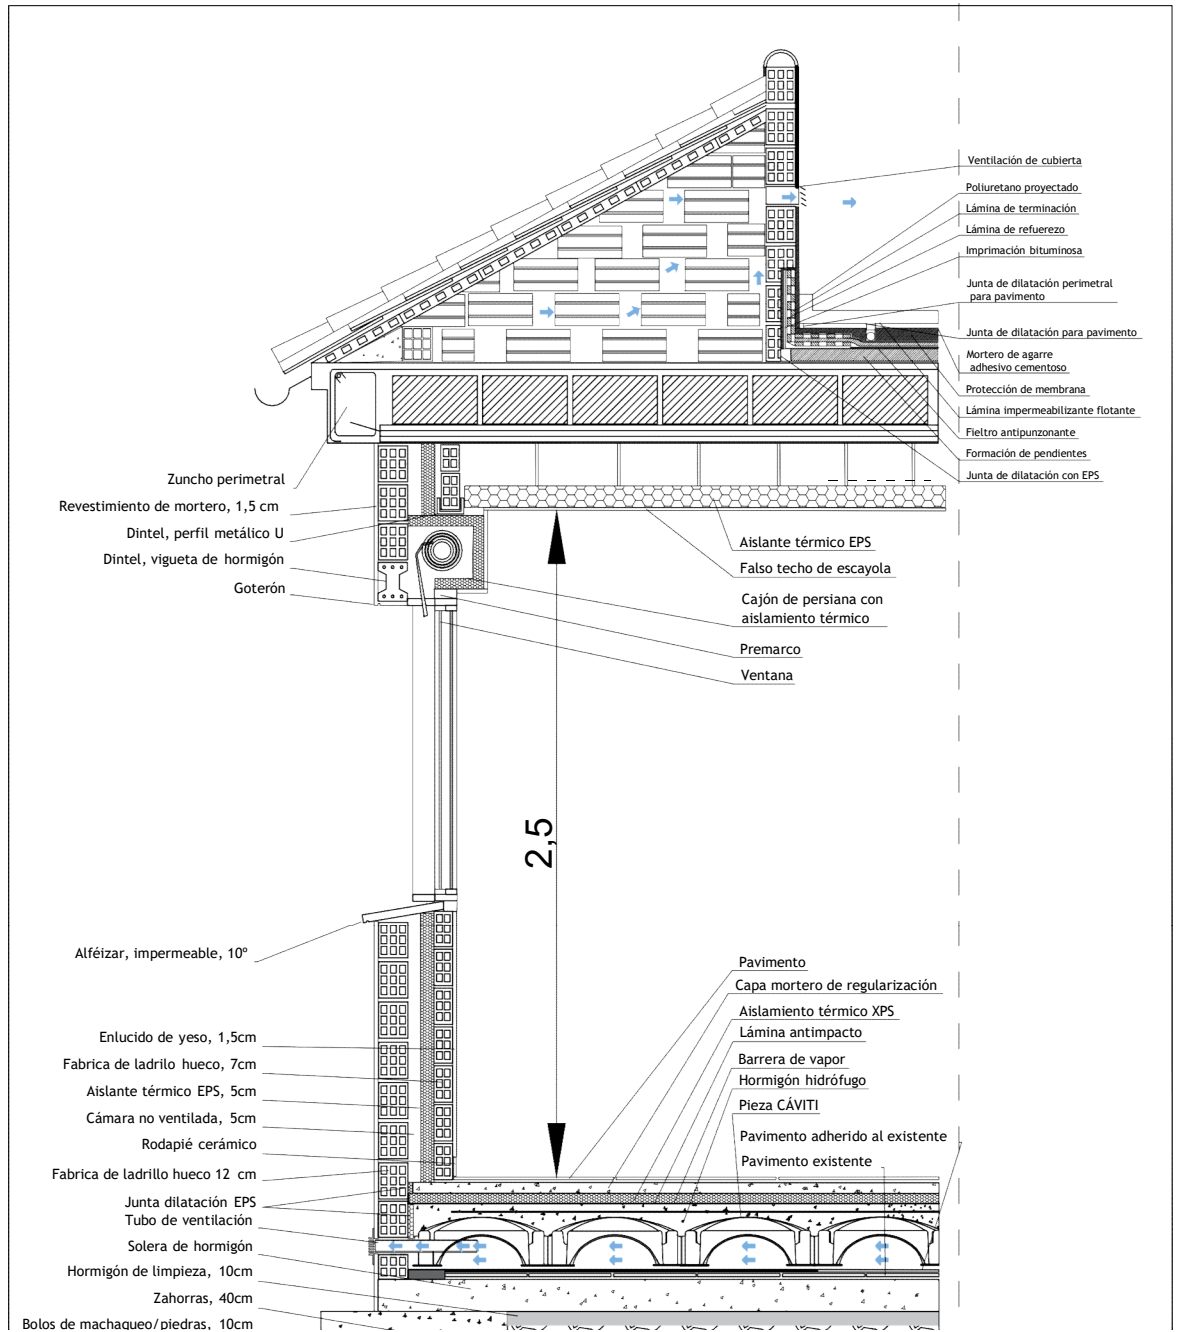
Sección constructiva Forjado sanitario (fuente autor)
